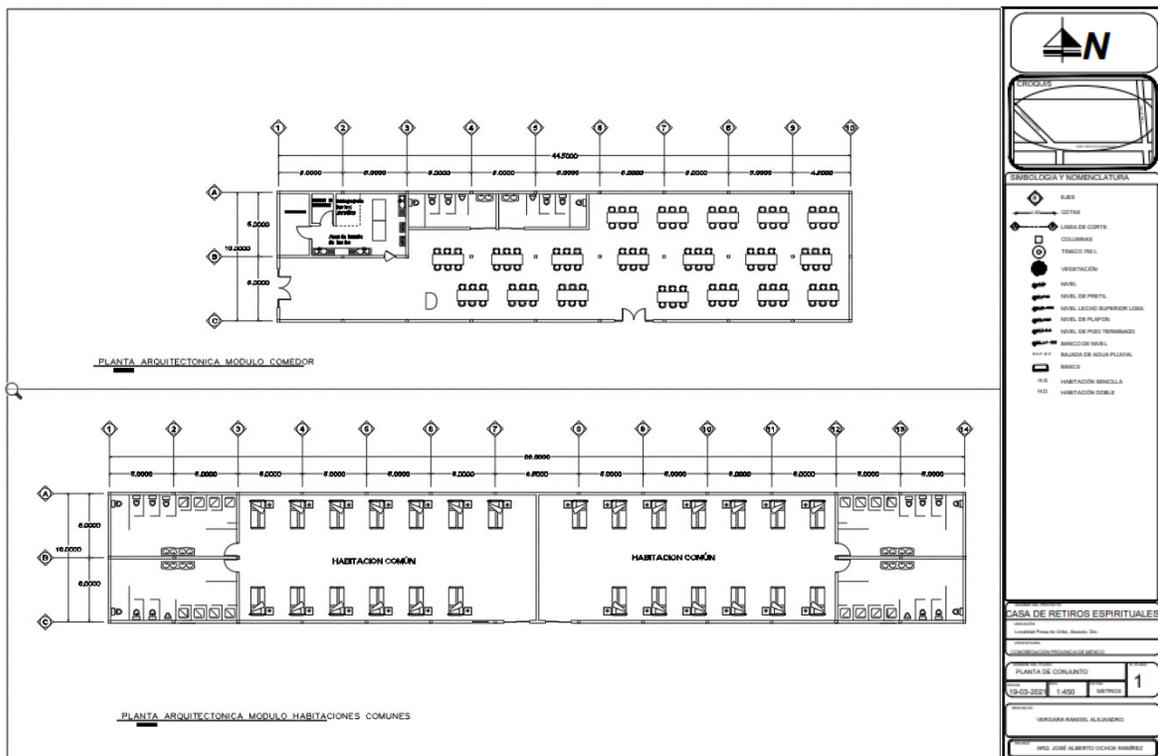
Anteproyecto Plantas arquitectónicas módulos comedor y hab. comunes. (Fuente propia, 2021)
